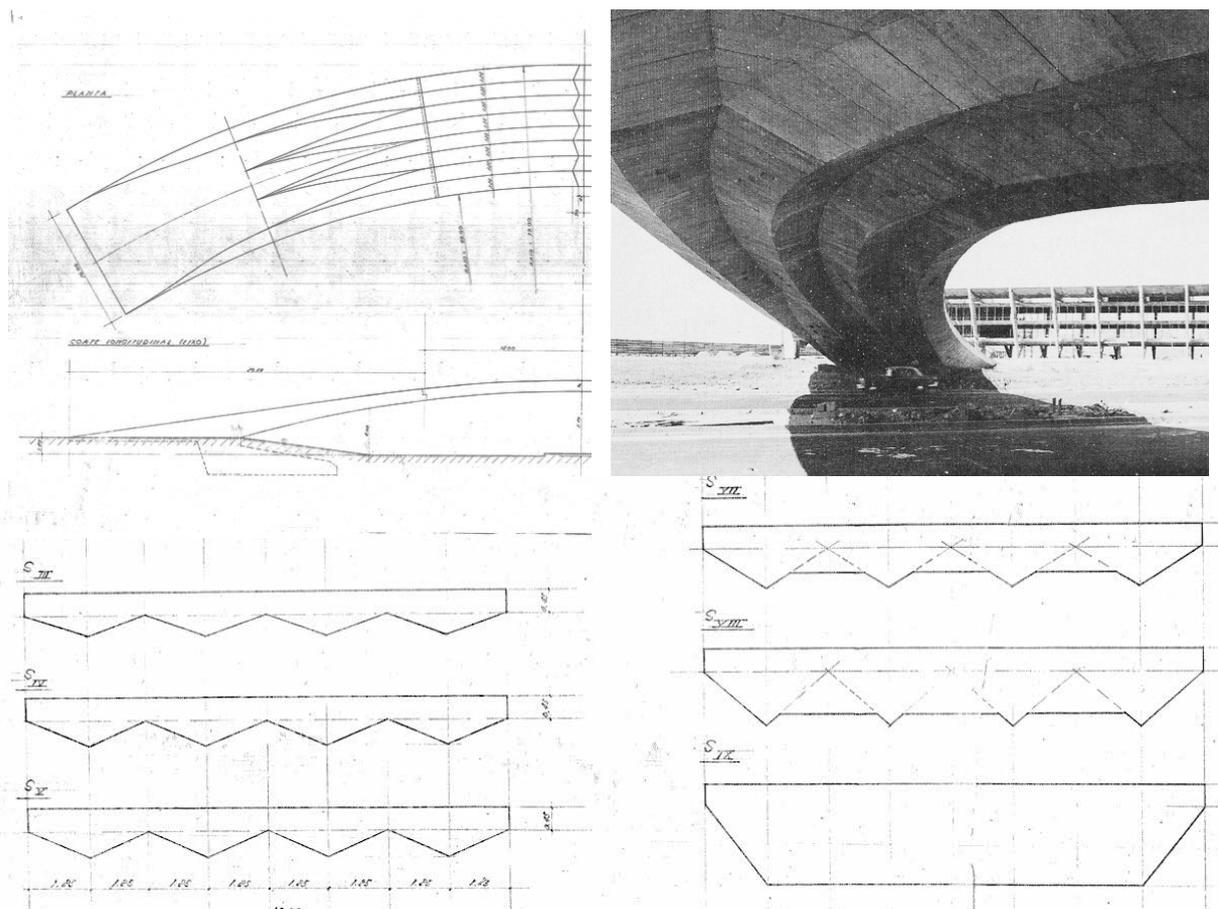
, 58. Vista e desenhos do projeto executivo original da Passarela Paulo Bittencourt. Planta e cortes do perfil em diferentes trechos.
